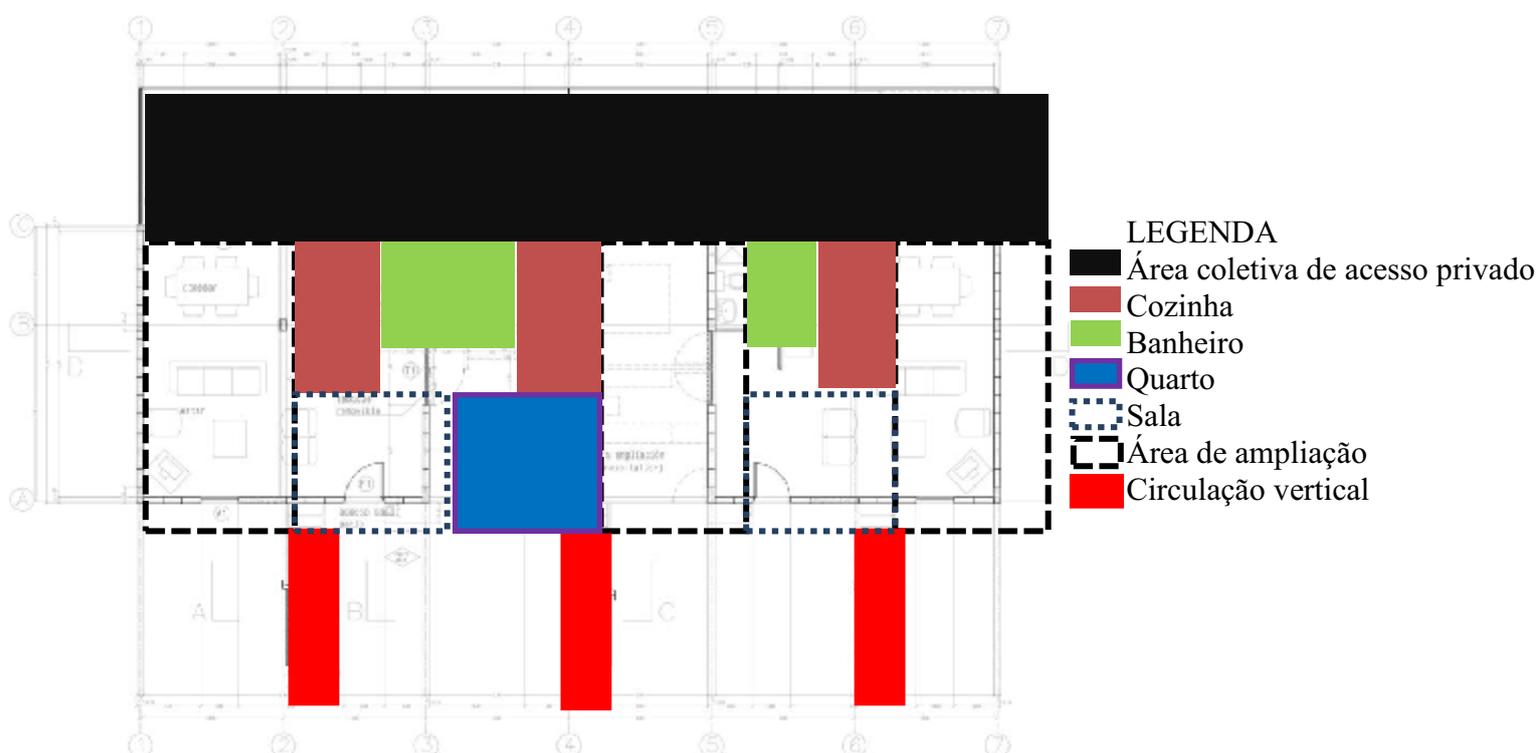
Quinta Monroy Planta de Térreo Fonte<: Archdaily > Acesso em Março de 2019
